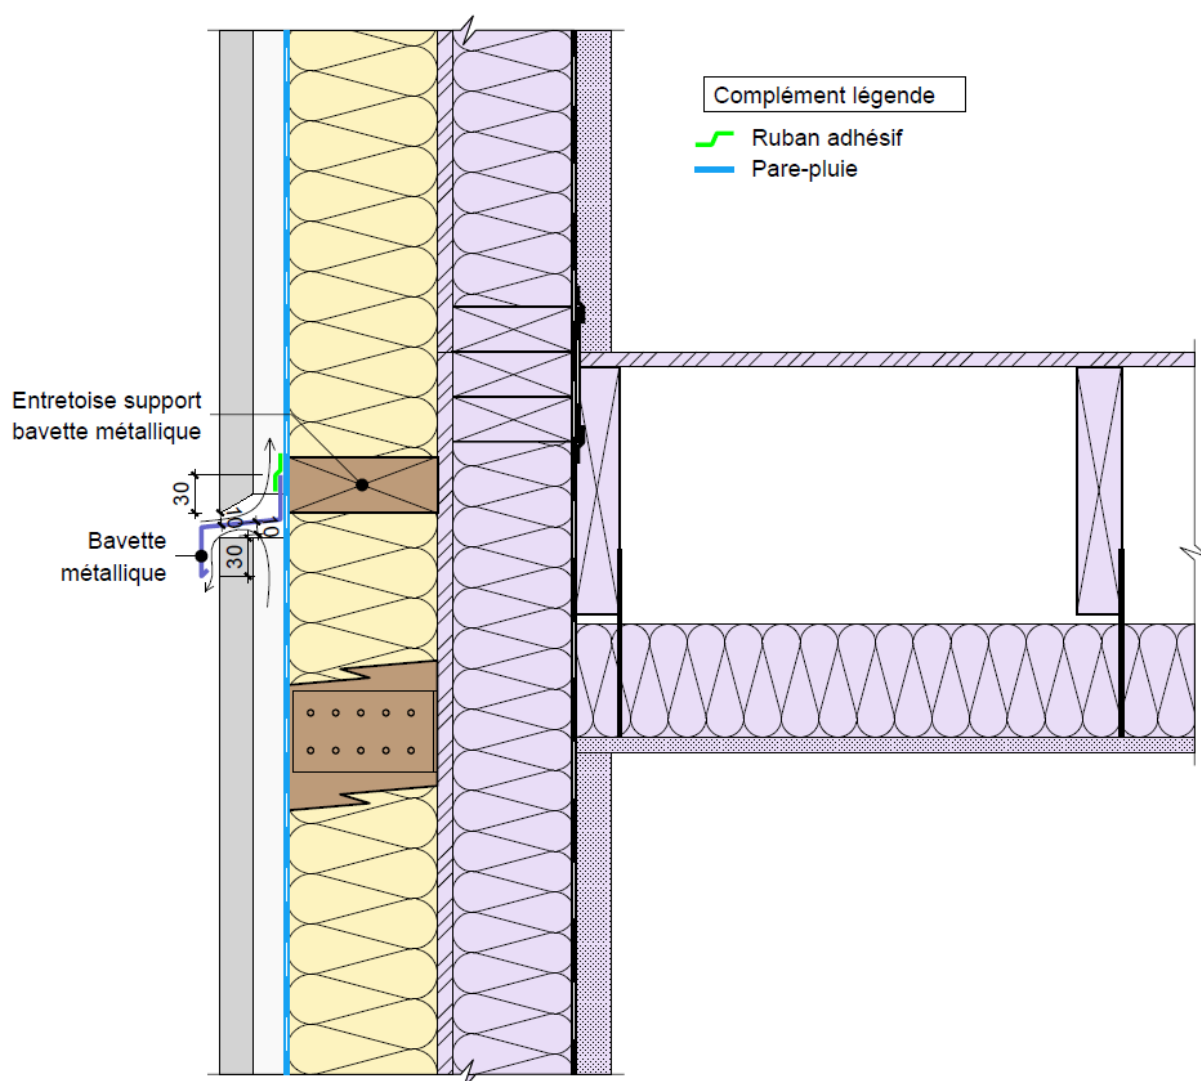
Plancher intermédiaire – avec recouplement de lame d’air du bardage (coupe verticale)
